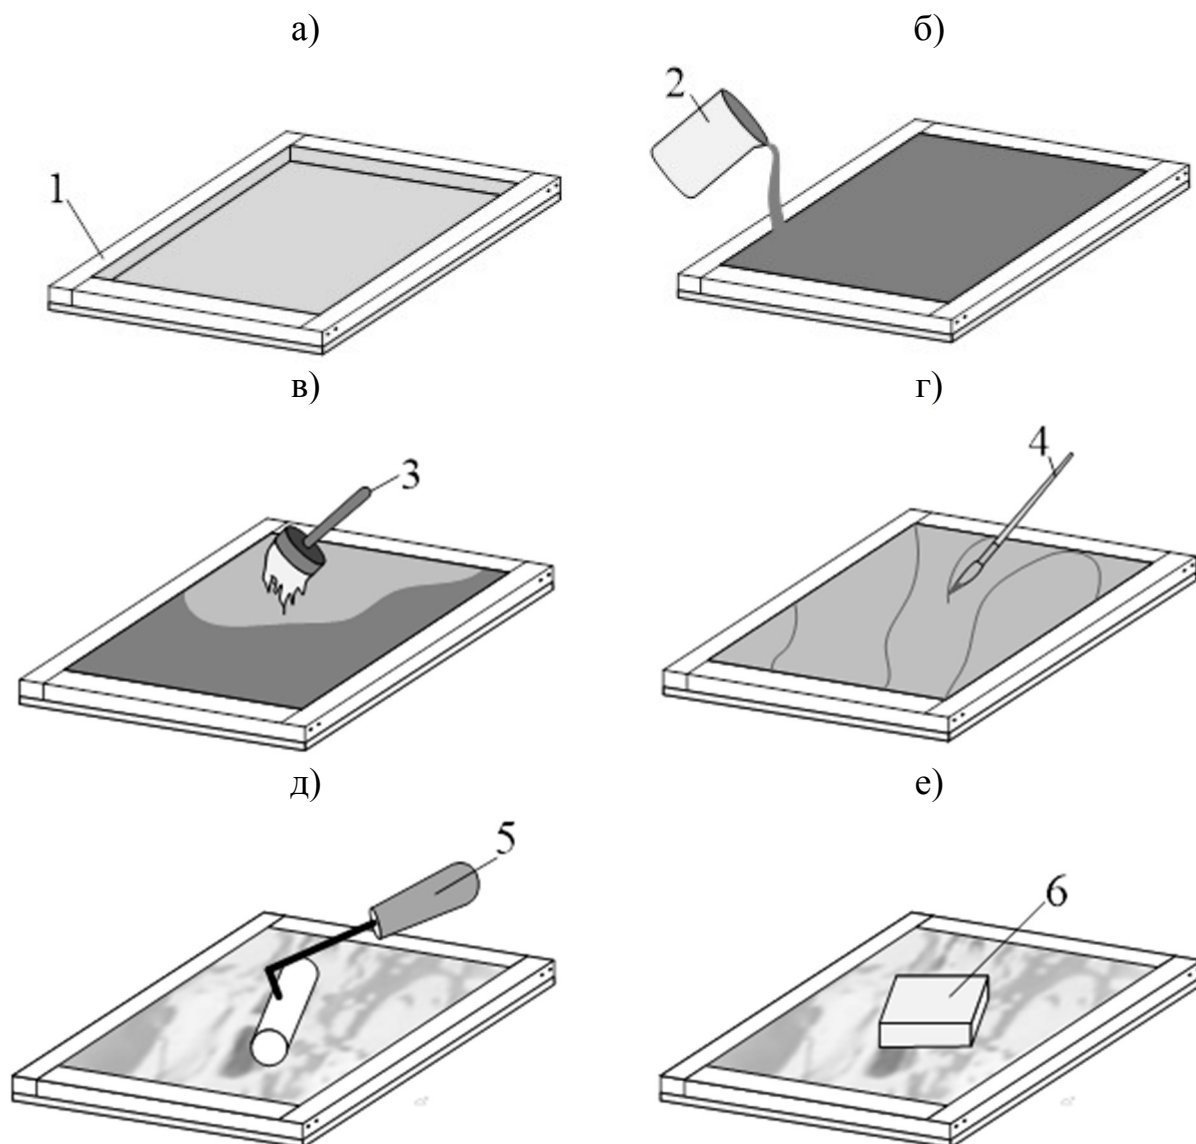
Изготовление утюжного мрамора: а – подготовленная форма; б – заливка гипсового раствора в форму; в – покрытие эмульсией; г – нанесение рисунка; д – обработка горячими утюгами; е – полировка; 1 – форма; 2 – емкость гипсовым раствором; 3 – широкая кисть; 4 – тонкая кисть; 5 – утюжок; 6 – губка
